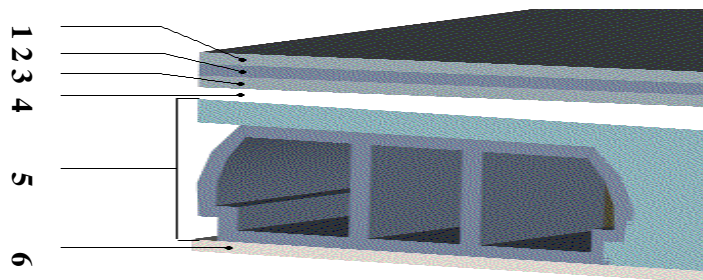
disposition des matériaux pour plancher à corps creux de la terrasse
